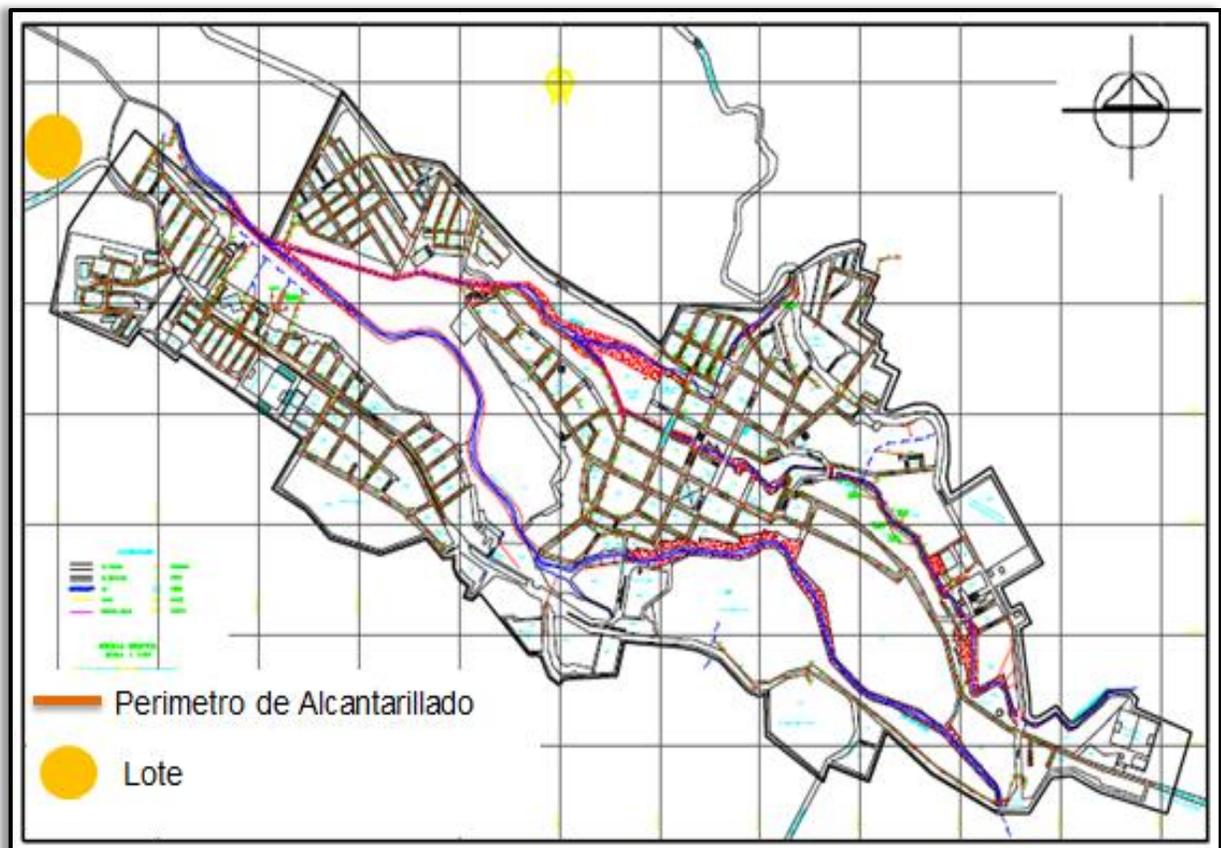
Plano de cobertura de servicio de alcantarillado en base al P.B.O.T, 2013
